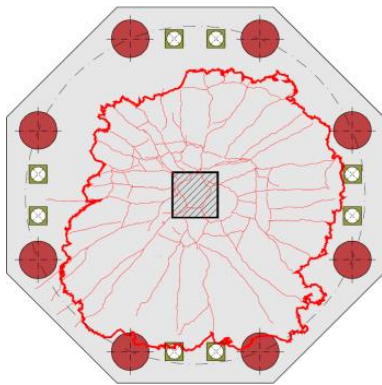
Abertura de fissuras das lajes ensaiadas.
